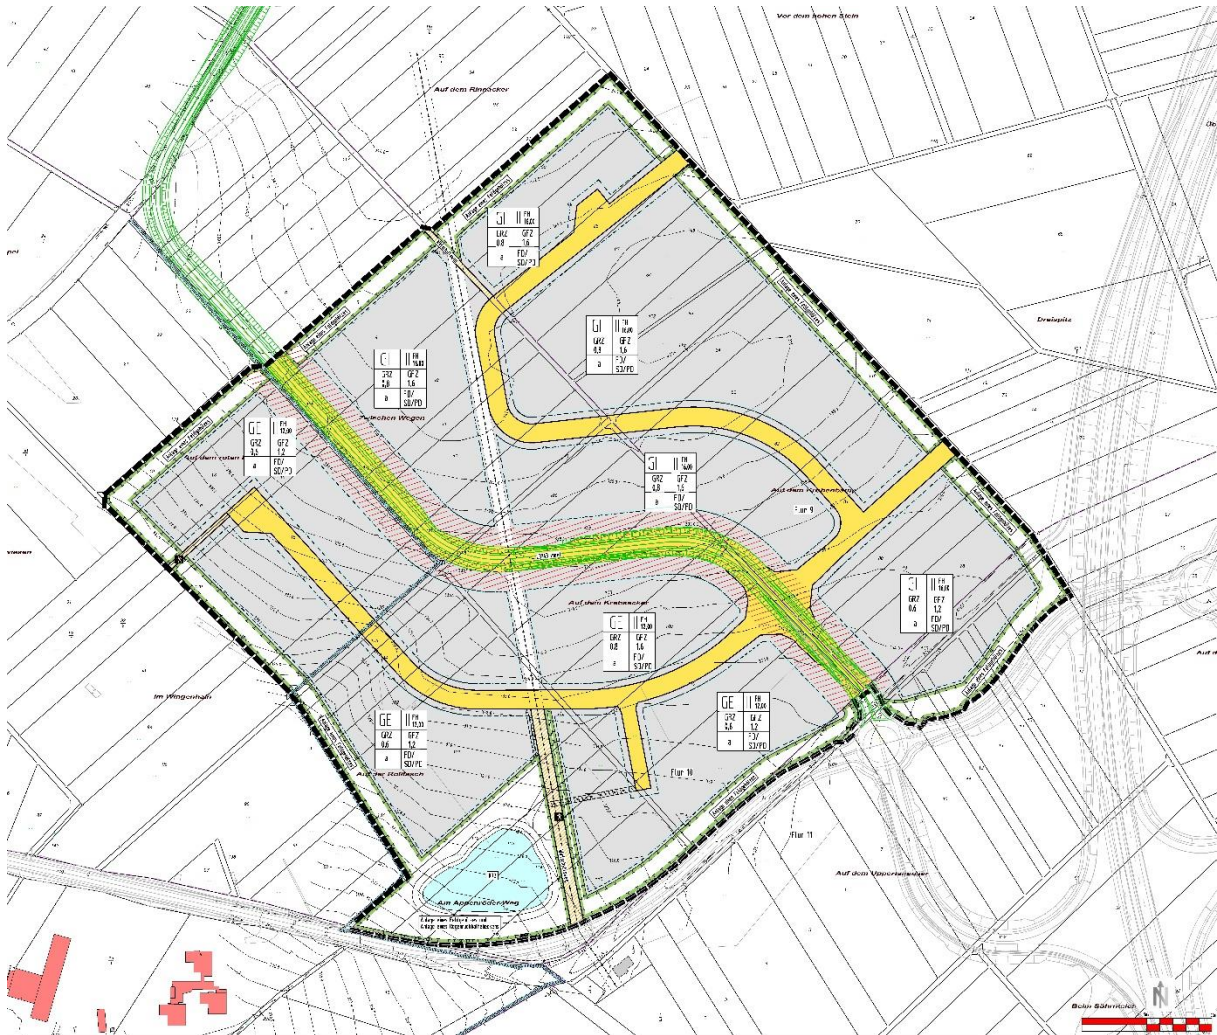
Planzeichnung des Bebauungsplanes Industrie- und Gewerbegebiet Am Roten Berg, Stand 2018 (Bauleitplanverfahren ruht)
